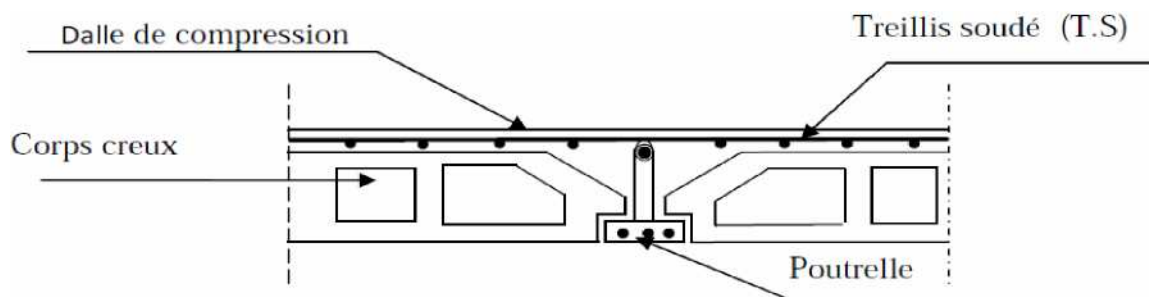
Coupe transversale d'un plancher en corps creux
